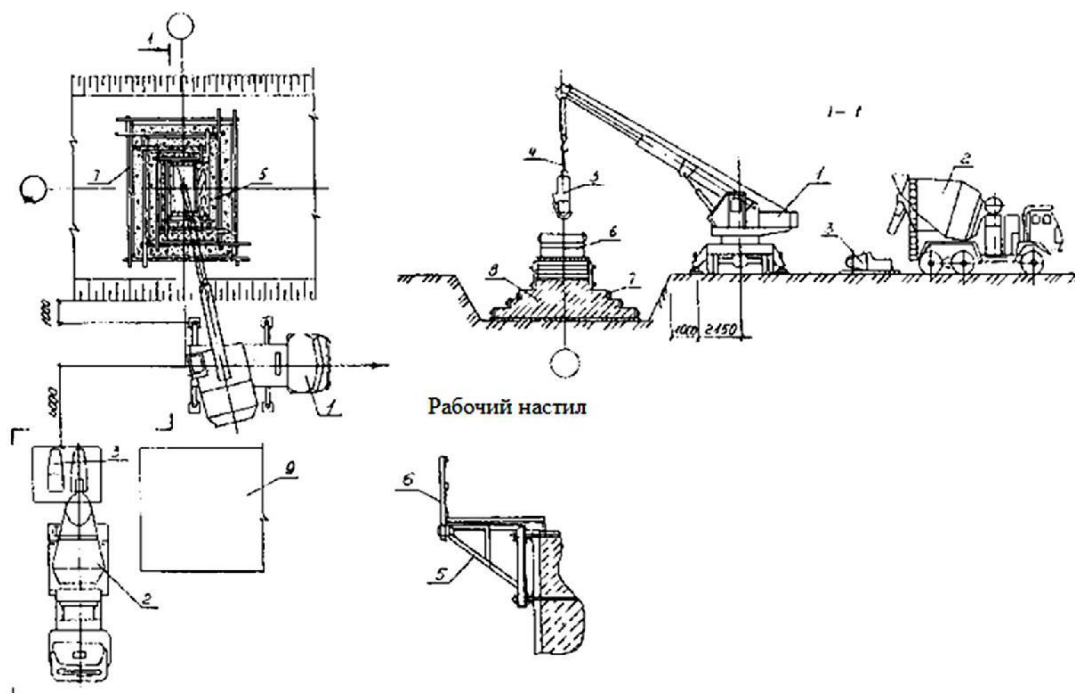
Схема производства бетонных работ при подаче бетонной смеси краном в Бункерах:
